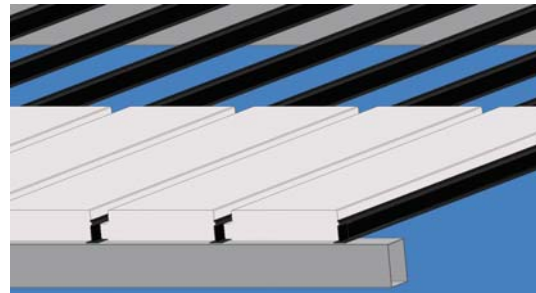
TERMOLOSA C-1520 sobre perfil CONDUVEN.
